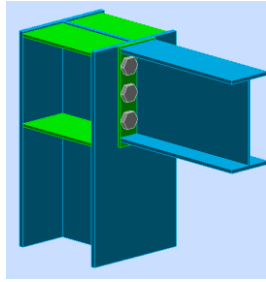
Pormenor da Ligação Coluna-Travessa (HEA 280 – IPE 240).
